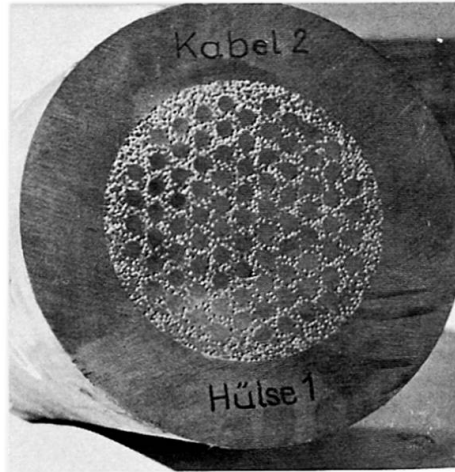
Querschnitt durch eine Ankerbrücke mit Kunststoff, Zinkstaub und Stahlkugeln.
